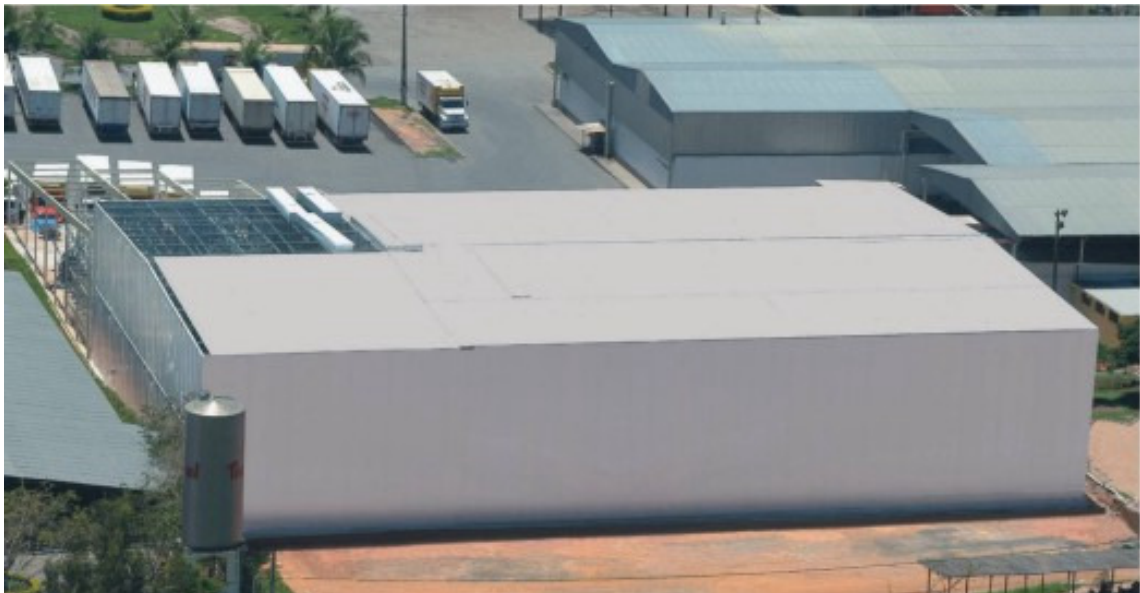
Foto de edificação com vedação fixada diretamente na estrutura do sistema de armazenagem, (Águia, 2005).
